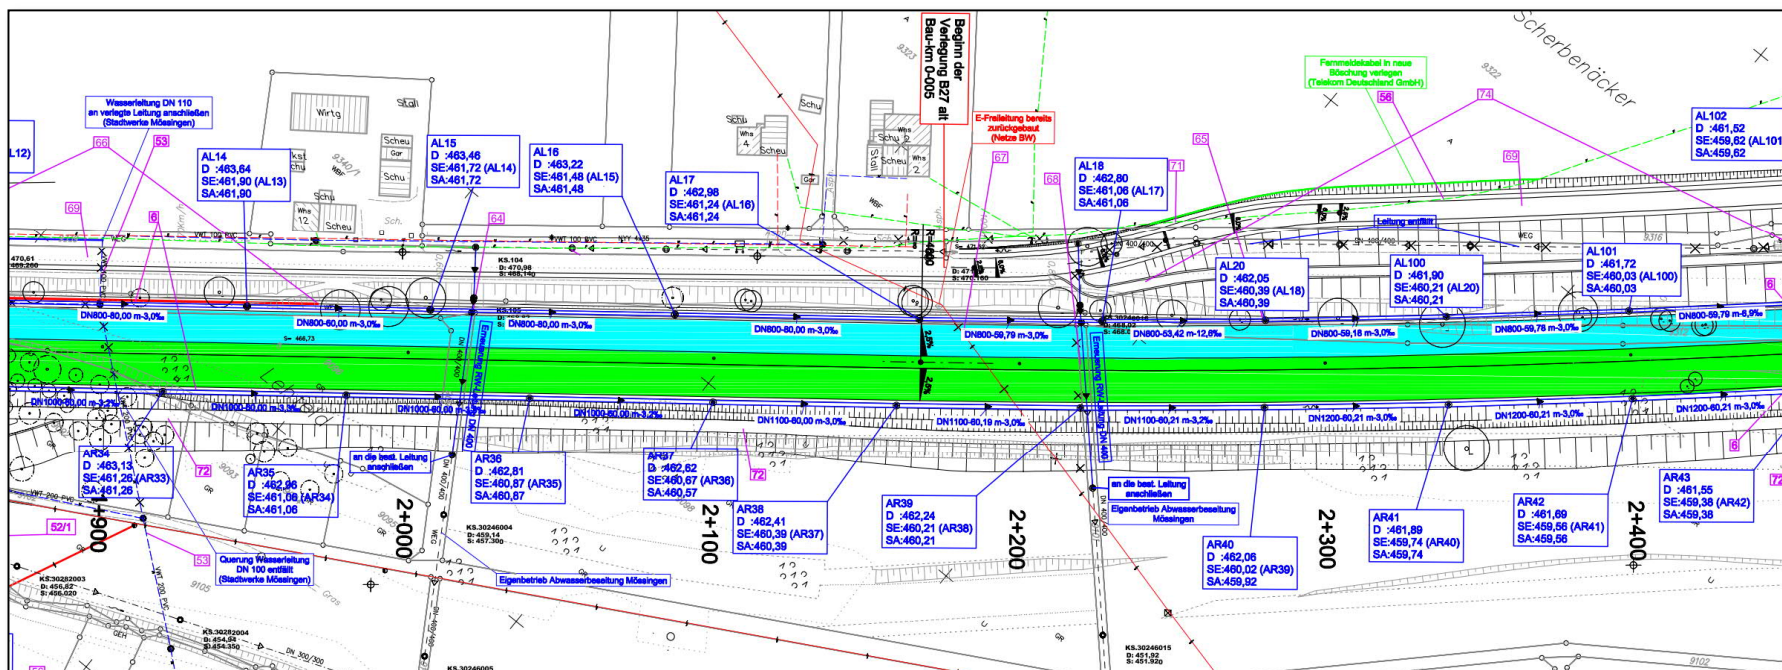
Entwässerungsabschnitt 1B: Stationen 1+900 bis 2+400. Straßenflächen mit erforderlicher Behandlung (Flächen, die nicht breitflächig in den Böschungen zur Versickerung gebracht werden können). Ohne Maßstab
